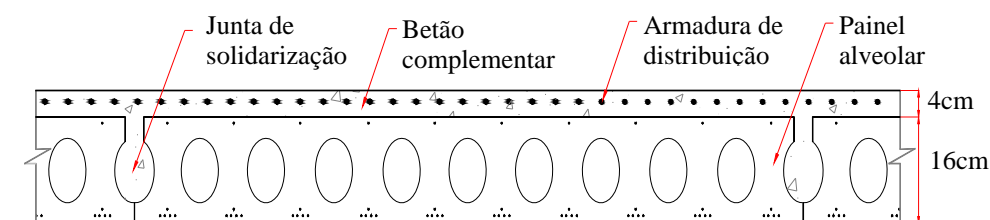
Pavimento de painéis alveolares sem isolante térmico (Pav7)
